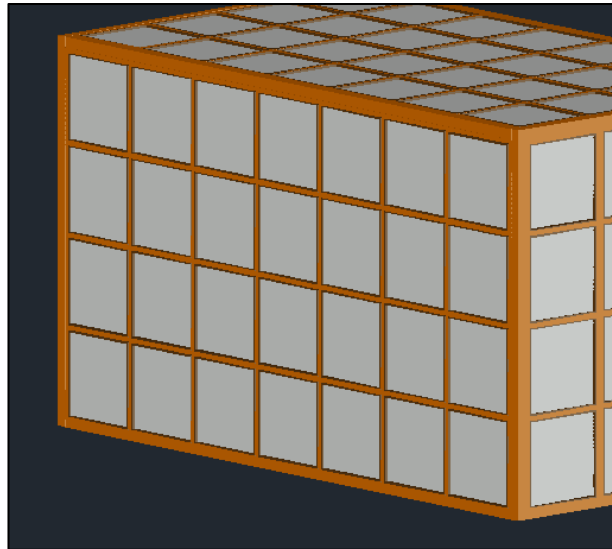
Vista global do lado onde será construída a fachada ventilada da câmara
